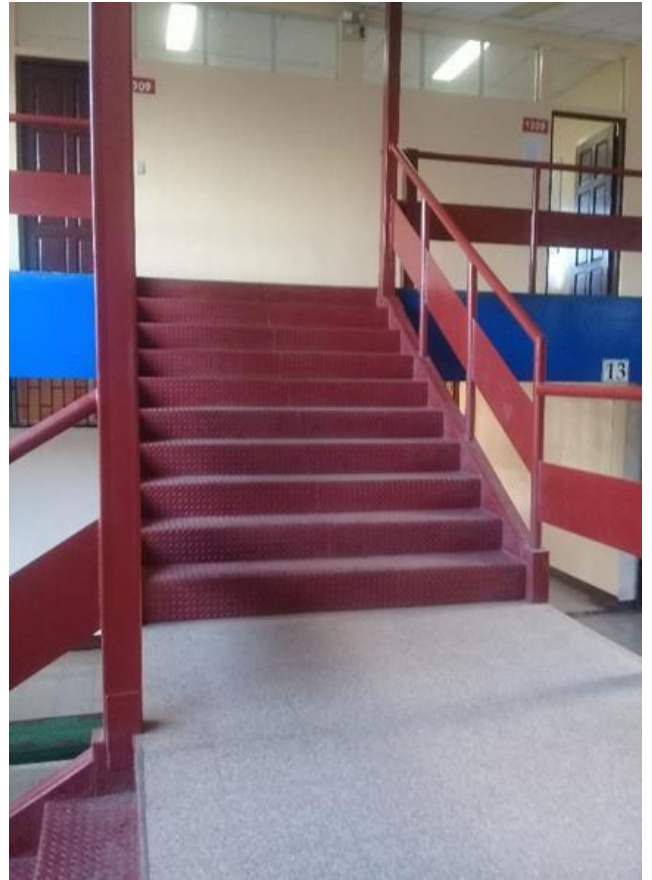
Vista Frontal, escaleras metálicas Pabellón 13.
